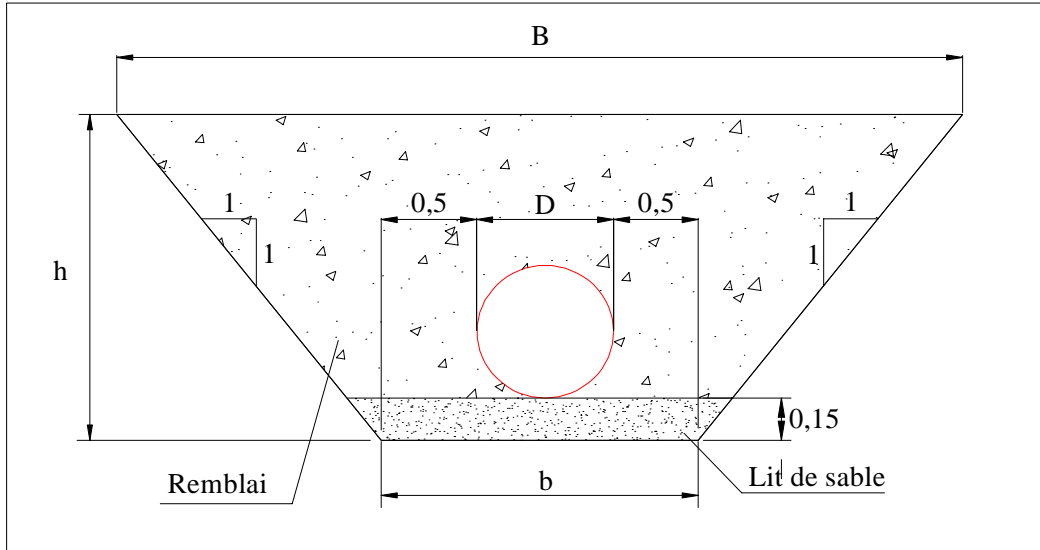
Coupes en travers de la tranchée de la conduite
